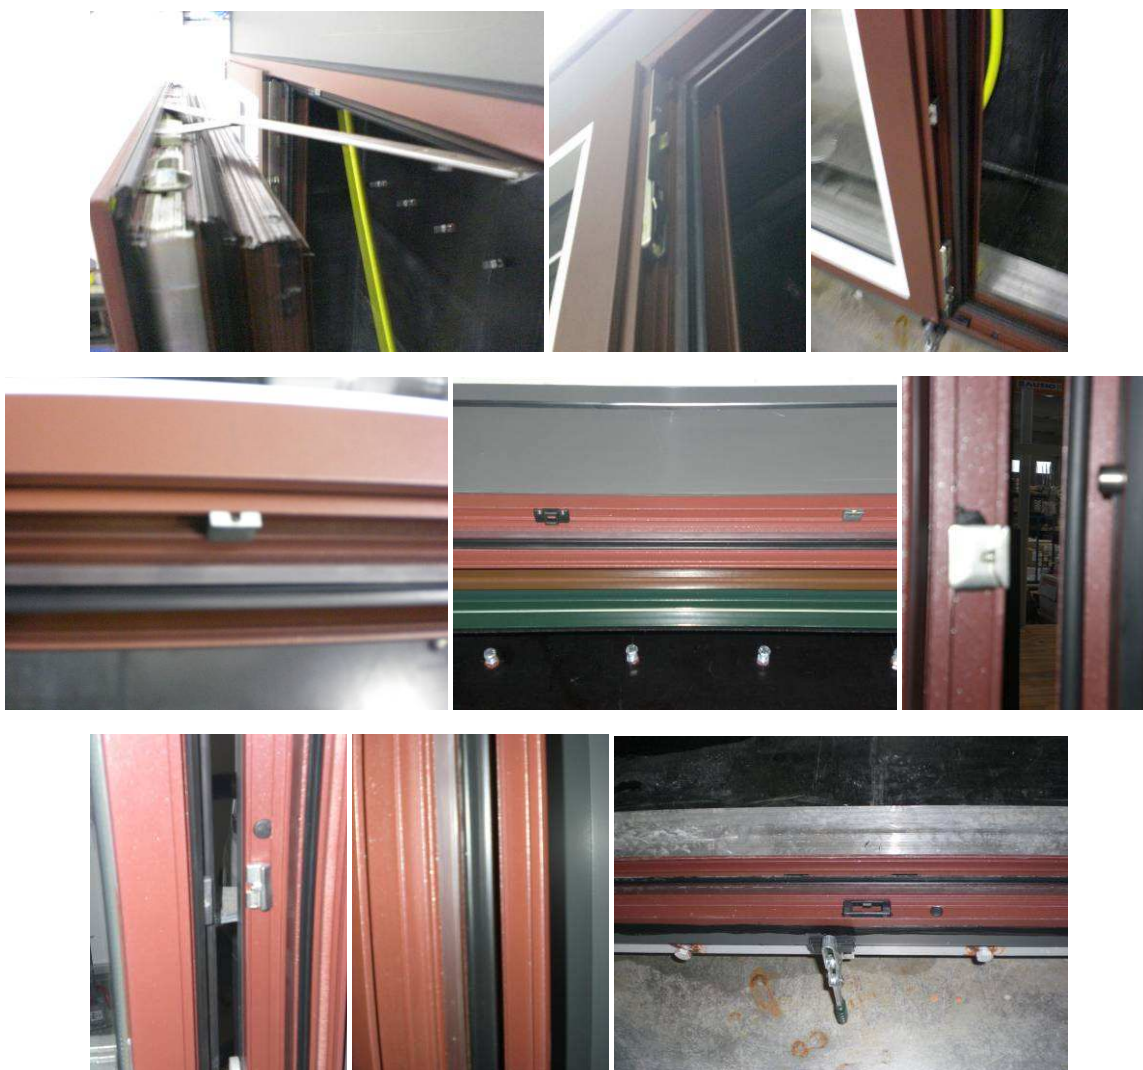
Detalle de perfil inferior, junta y drenaje.
